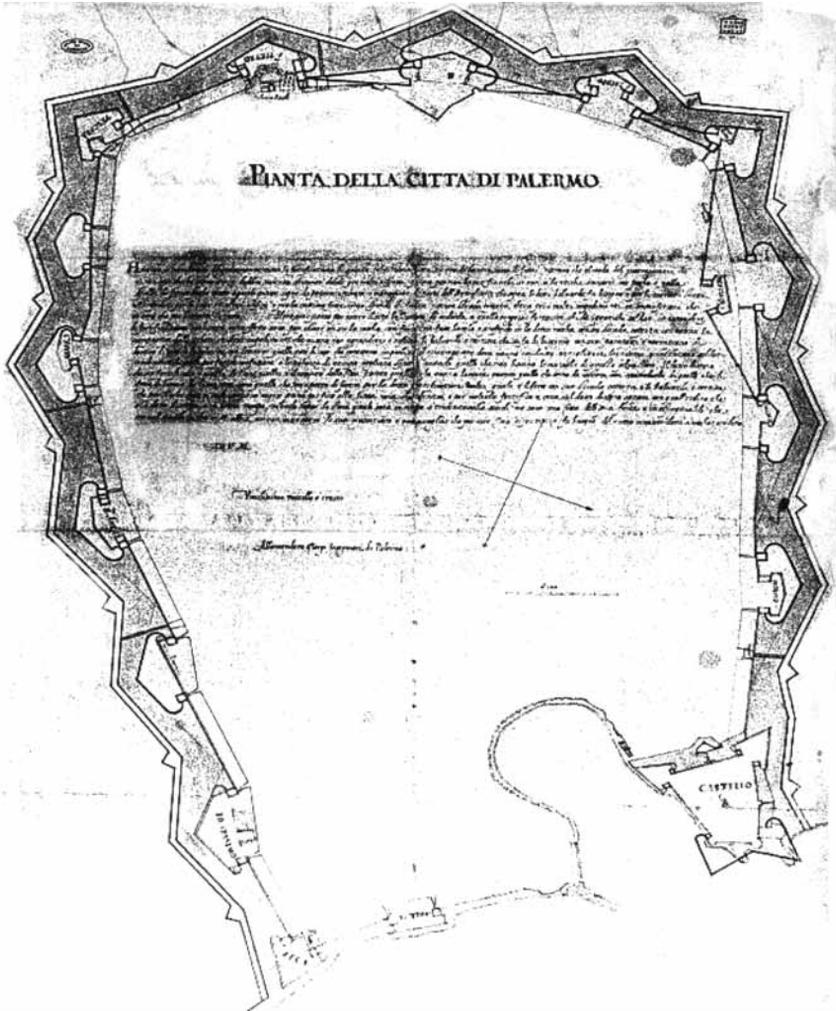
Pianta del recinto fortificato della città di Palermo, secondo Alessandro Giorgi - Palermo, 27 aprile 1575 (Ags, Mpyd, IX-60).
